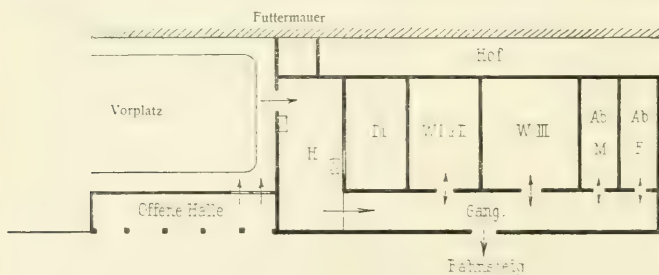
Gebäude mit Eingang vor Kopf (Semmering).
